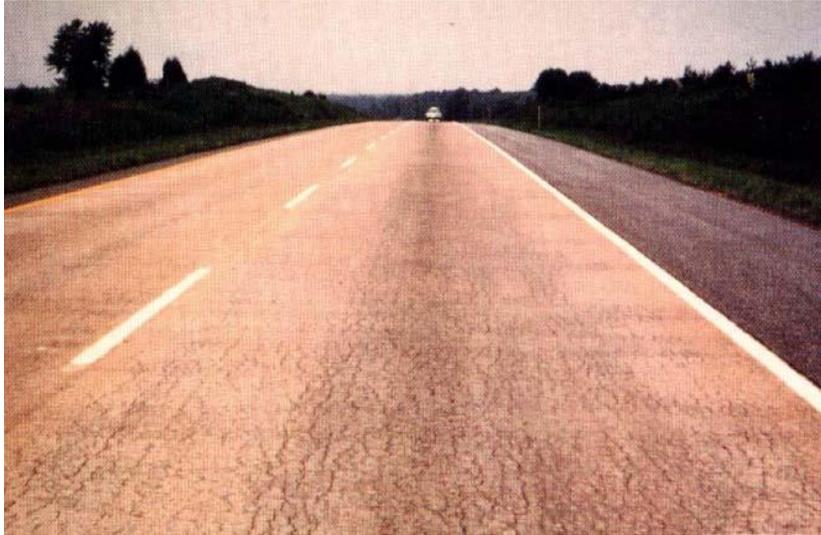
Pavimento de concreto afectado por una fisuración debida a la reacción álcali-carbonato
